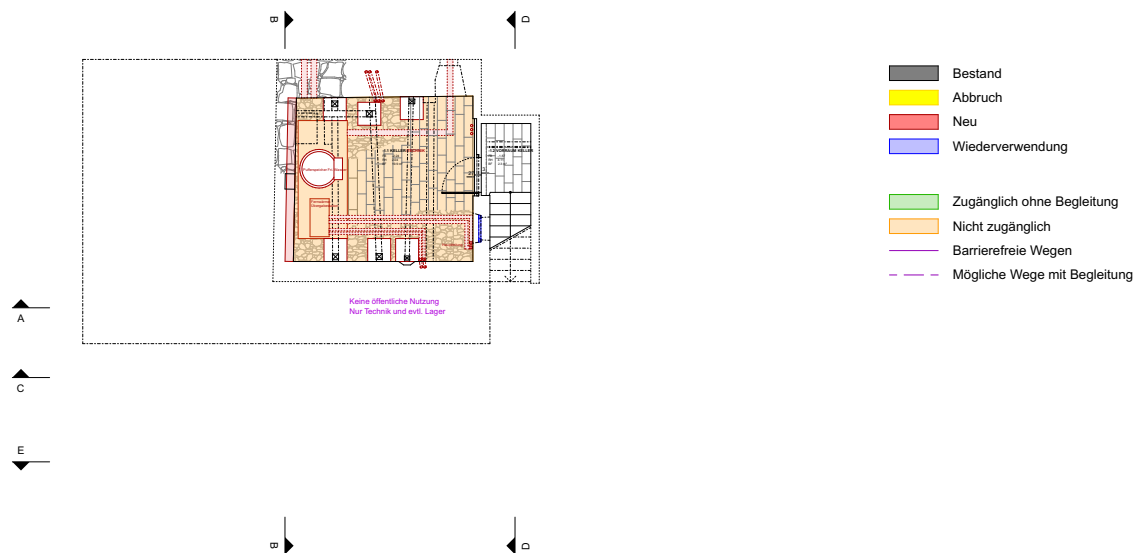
Grundriss UG Zugänglichkeit Konzept
